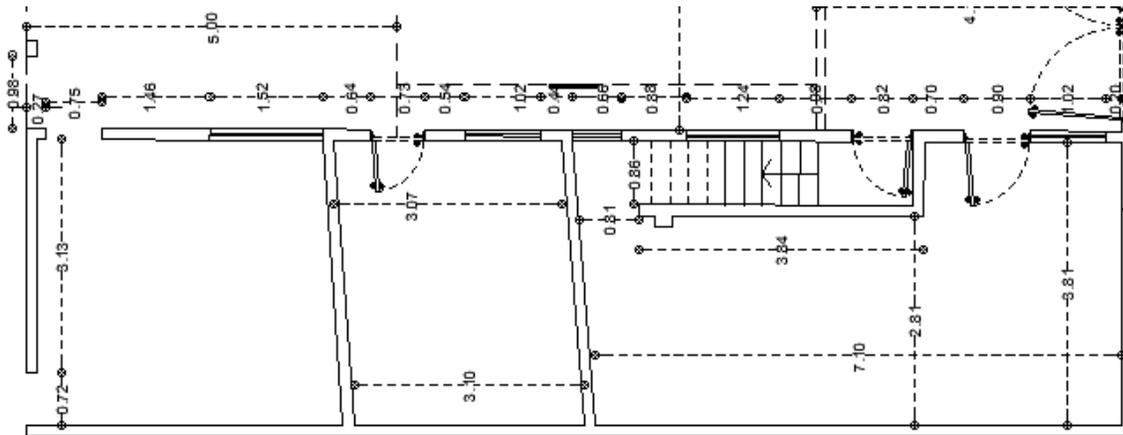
Levantamiento arquitectónico casa de Sra. Margarita
